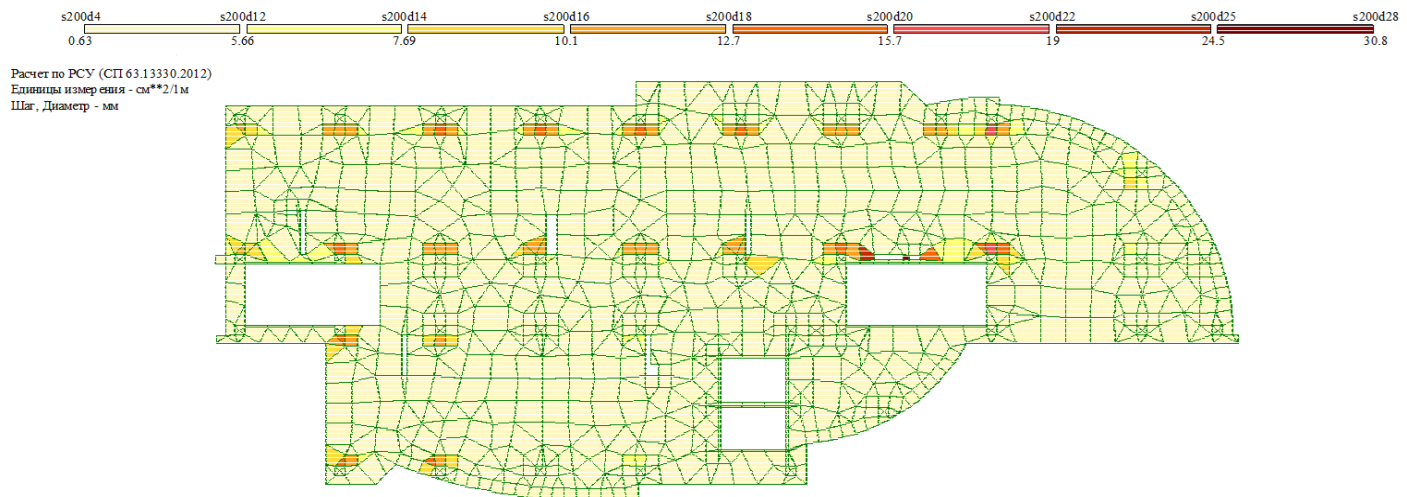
Армирование плиты перекрытия по Y верхняя зона
